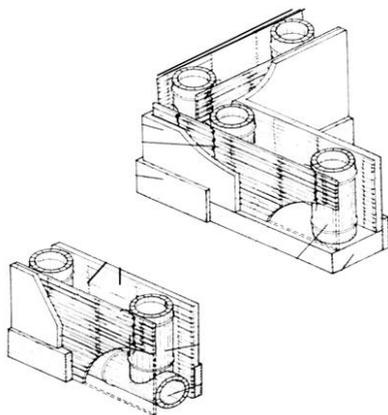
Detalhes construtivos dos painéis do tipo bahareque.
